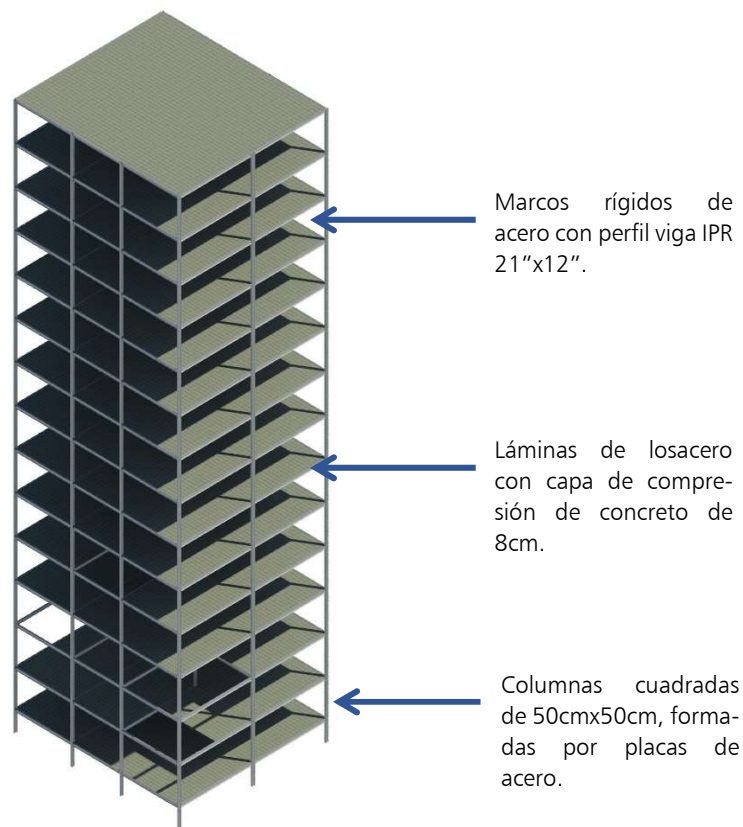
Propuesta Estructural. Edificio INDAABIN.
